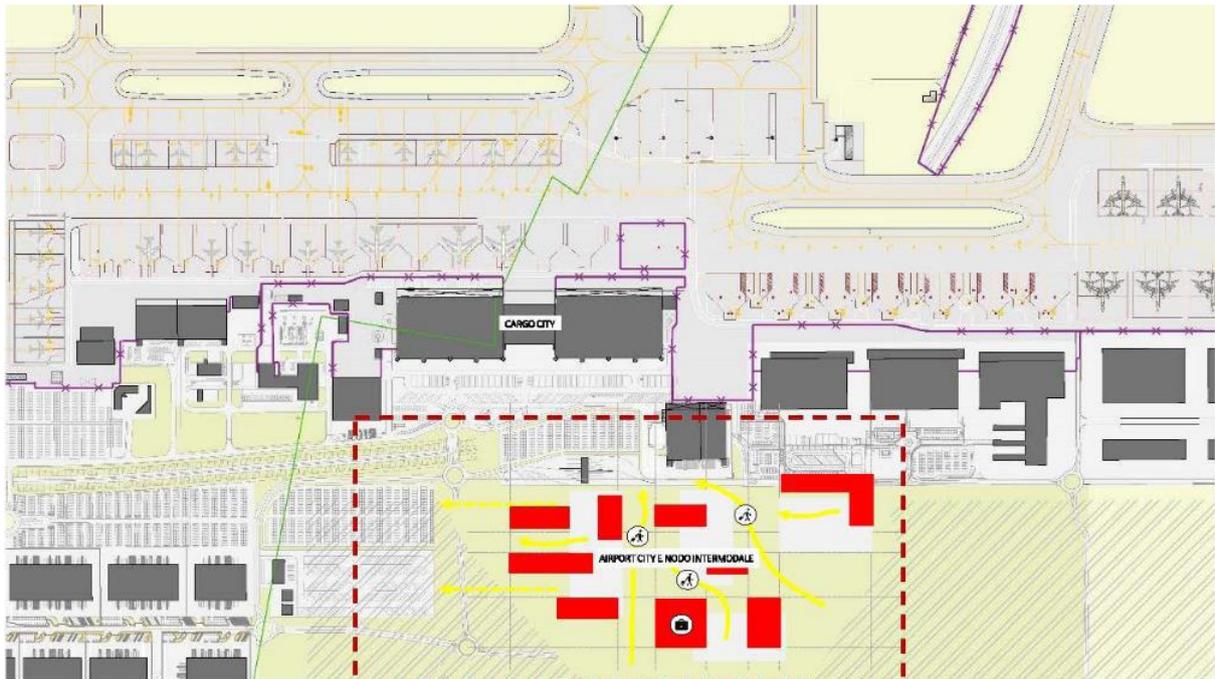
Ipotesi 1 schema di layout fonte: Masterplan 2035
